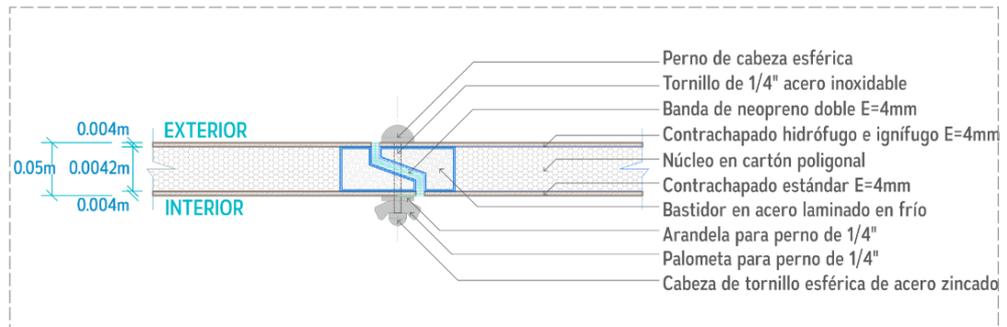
, Detalle en planta de unión entre paneles de cerramiento, fuente: Autor.
